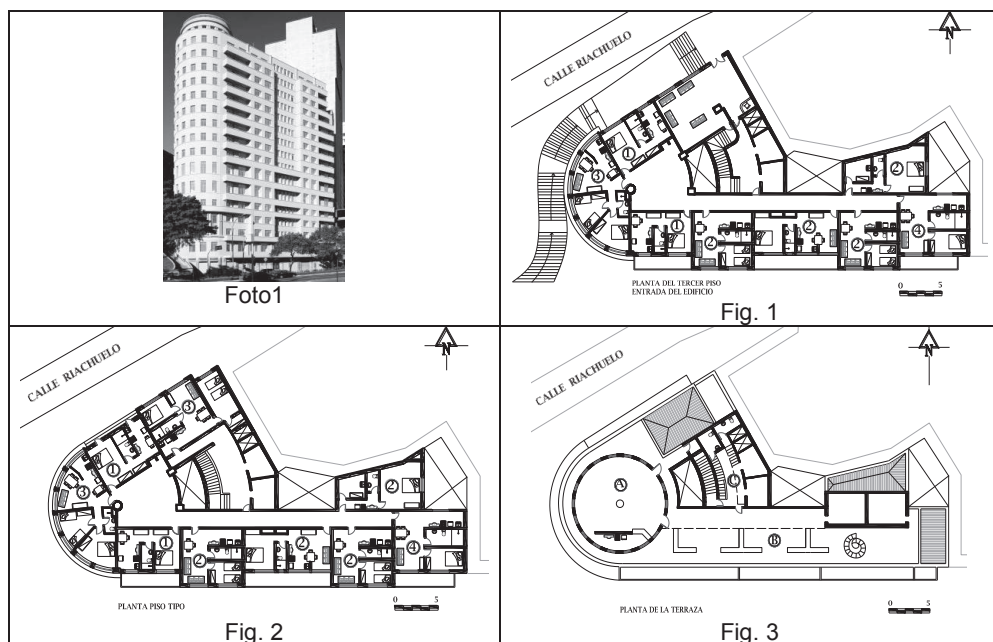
Fachada del Edificio Riachuelo después de la intervención arquitectónica. Fuente: Paulo Bruna Arquitectos Asociados, 2011. Figura 1. Edificio Riachuelo: Planta del primer piso. Figura 2. Edificio Riachuelo: Planta del piso tipo. Figura 3. Edificio Riachuelo: Planta de la terraza. Leyenda: (1) Vivienda múltiple uso, área entre 26 a 37m²; (2) Vivienda con 1 dormitorio, área entre 34m² hasta 38m²; (3) Vivienda con 2 dormitorios, área entre 47m² hasta 49m²; (4).Vivienda con 1 dormitorio adaptable para deficiente físico, área 44m².
